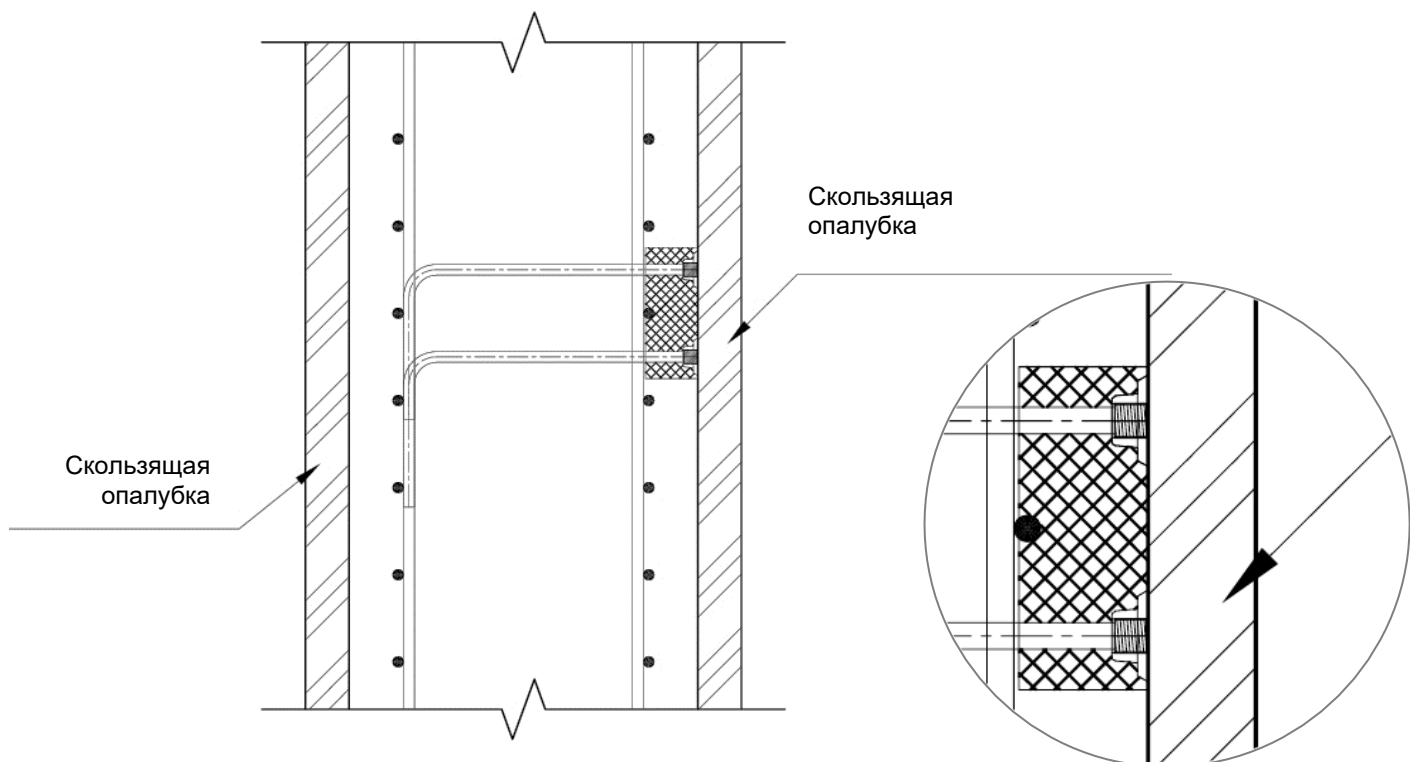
Установка и подъем скользящей опалубки
